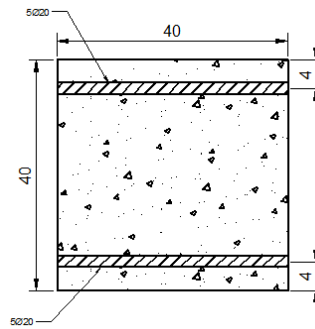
Sección transversal de la columna de hormigón armado.
